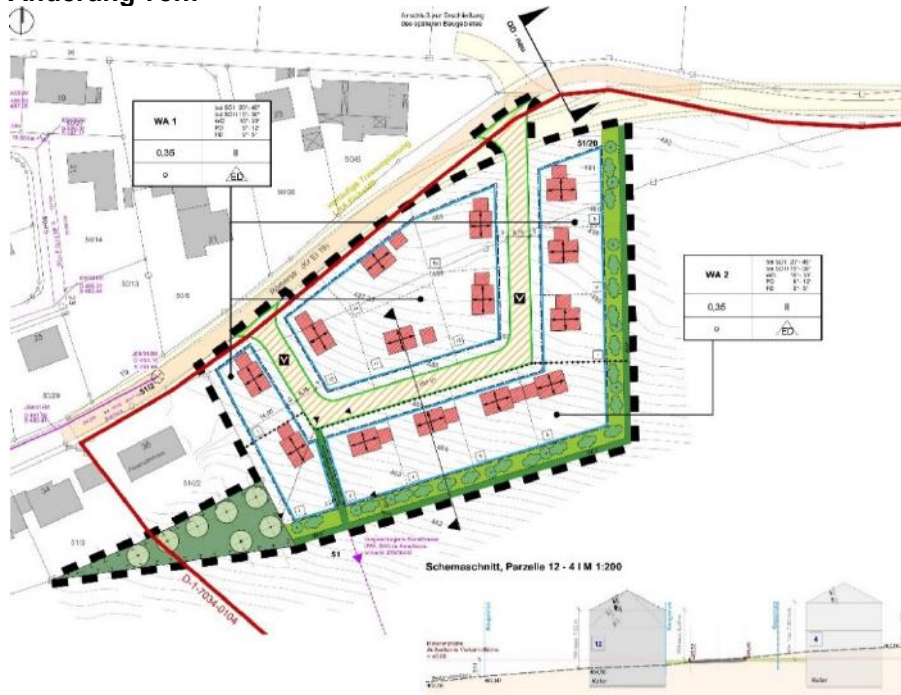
rechtskräftiger Bebauungsplan, ohne Maßstab
